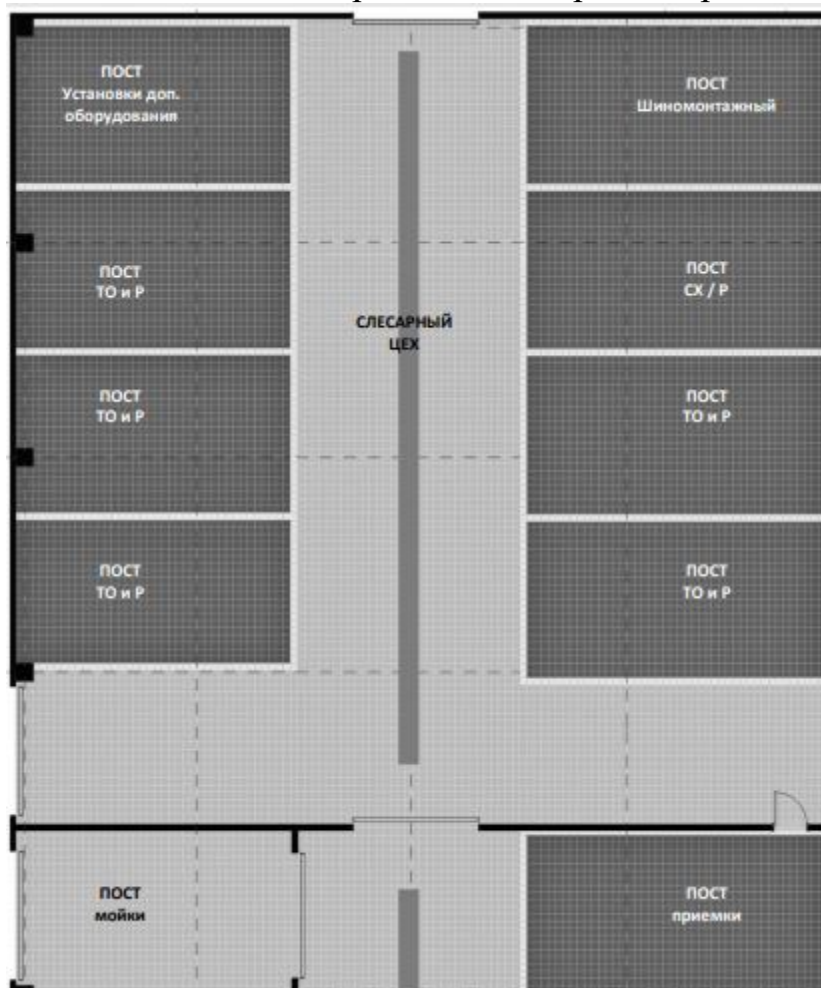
План раскладки напольной плитке в слесарном цехе и прямой приемке.
